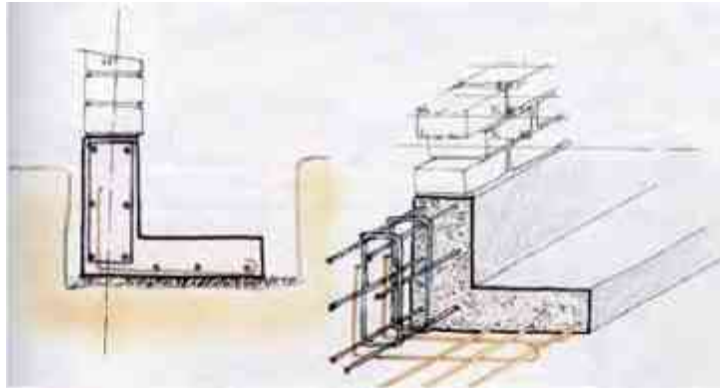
Ejemplo de zapata corrida. Fuente: <http://www.elconstructorcivil.com/2012/05/zapatas-corridas-de-concreto-armado.html>
